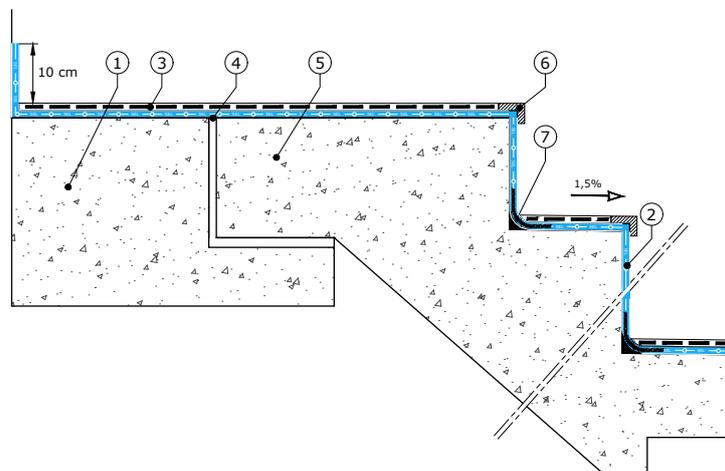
Jonction escalier préfabriqué/palier par joint sec - Exemple
